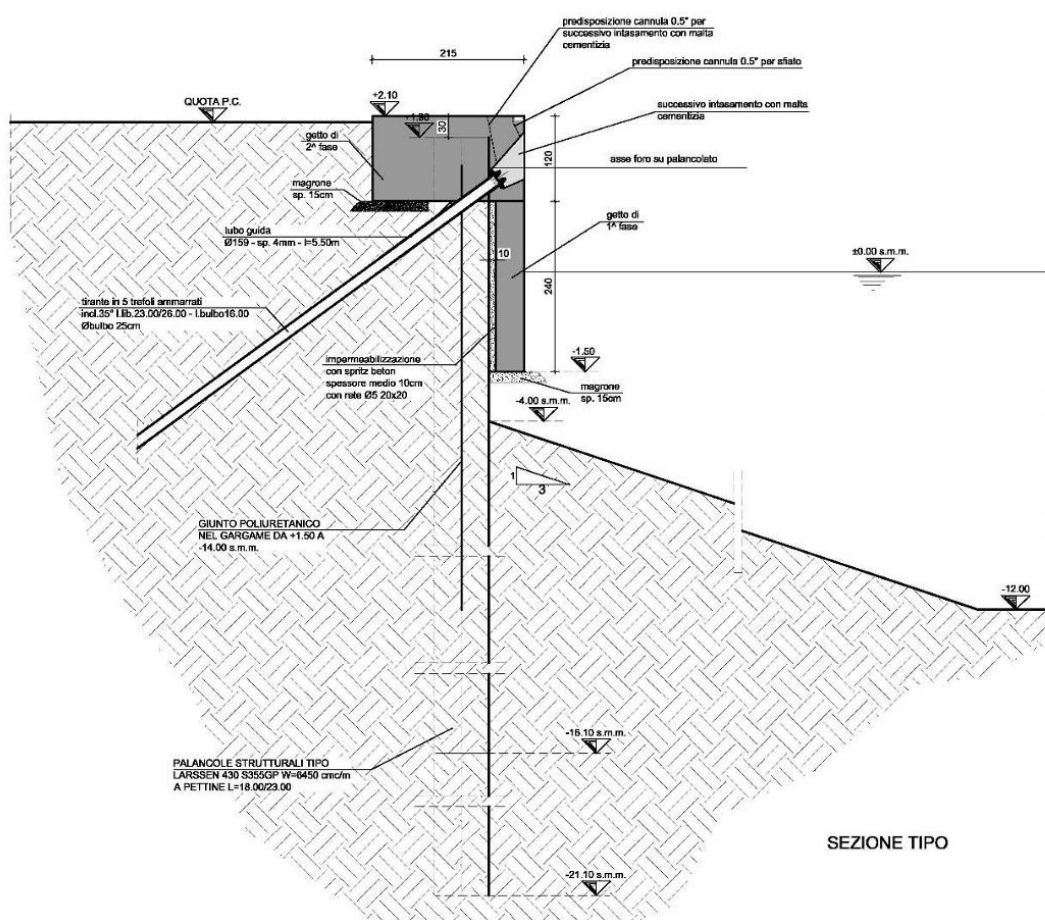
Sezione tipo del palanco lato in sponda.
